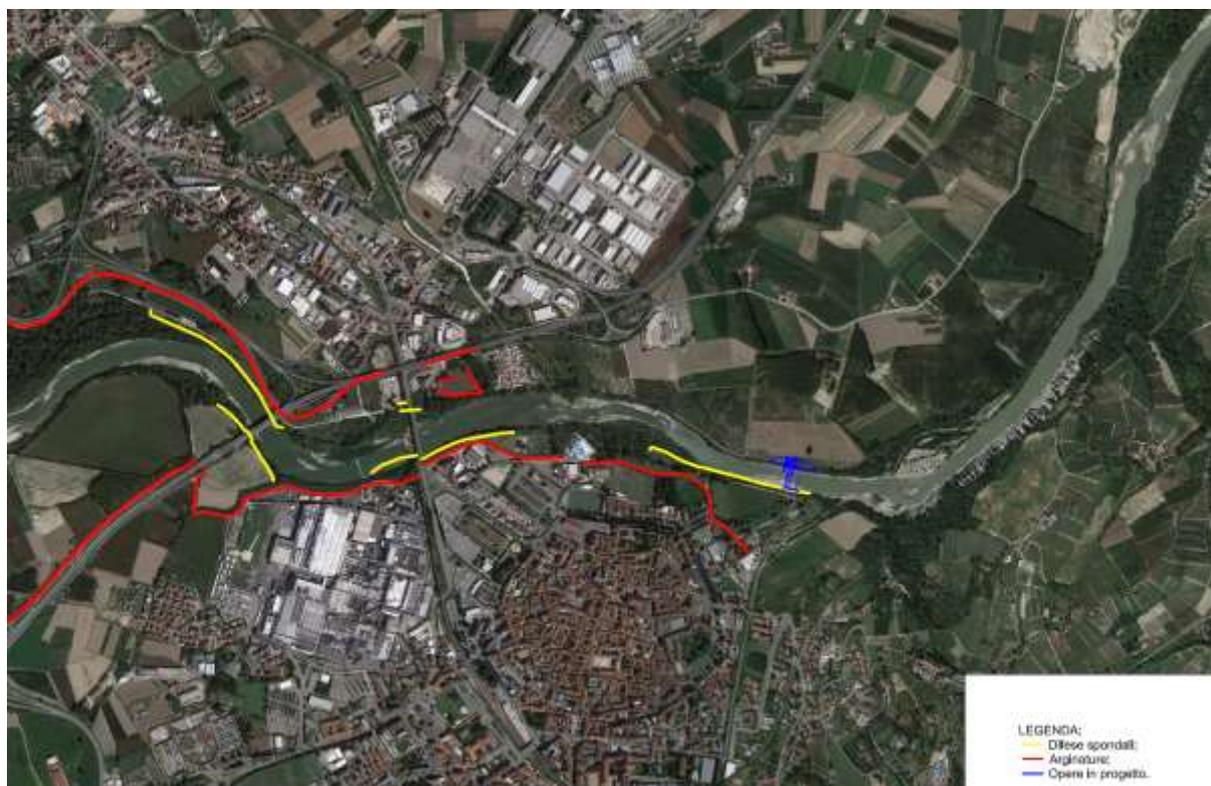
Planimetria opere idrauliche di difesa con sovrapposizione impianto "corto"
